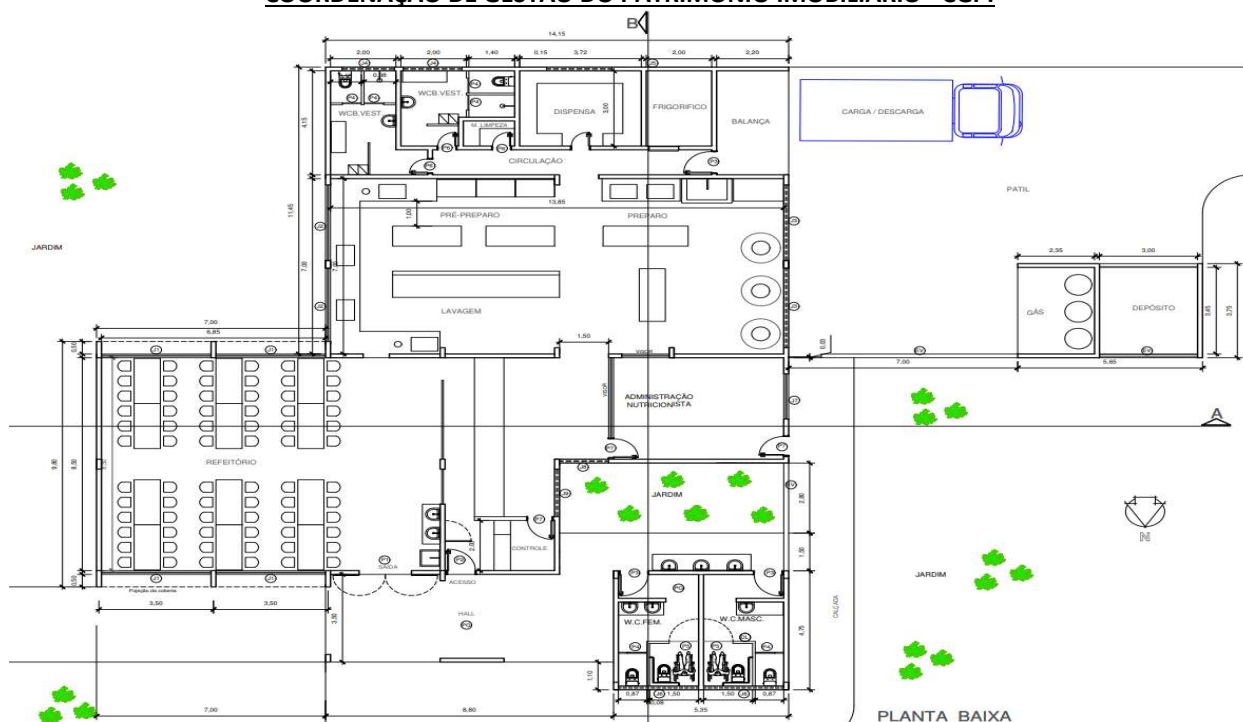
Planta Baixa da Edificação. Fonte: PU/UFCG
